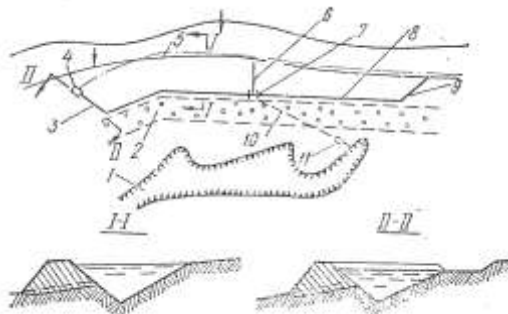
Размещение водозадерживающего вала-канавы у вершины оврага
